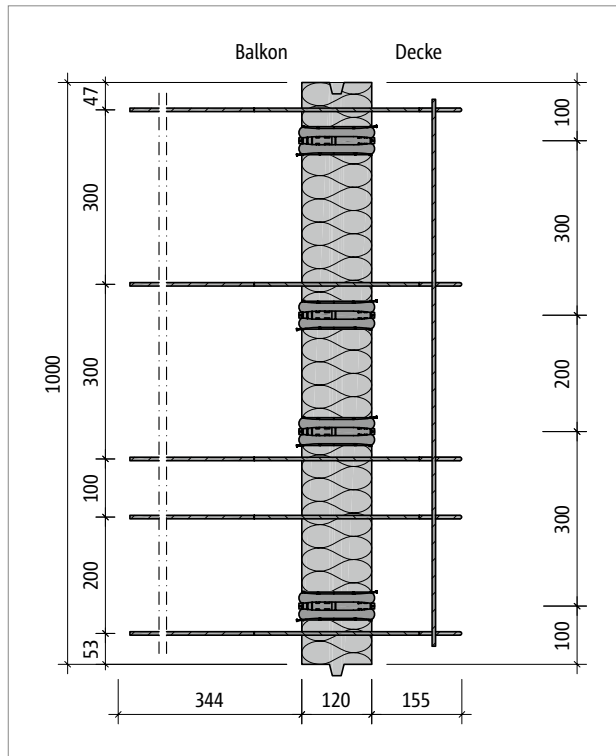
Schöck Isokorb® XT Typ QL-V1: Produktgrundriss
